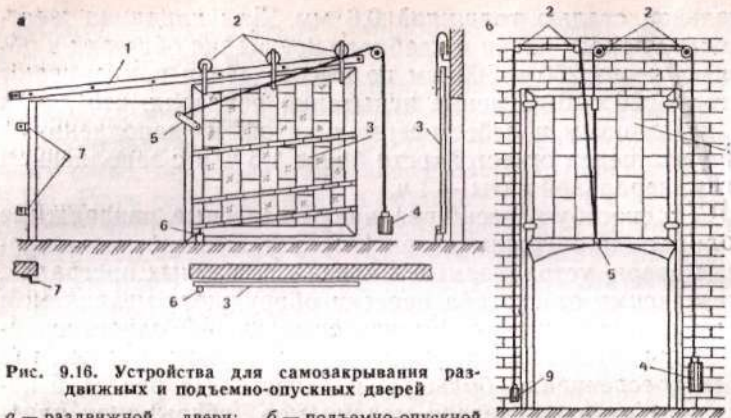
Устройства для самозакрывания раздвижных и подъемно-опускных дверей
